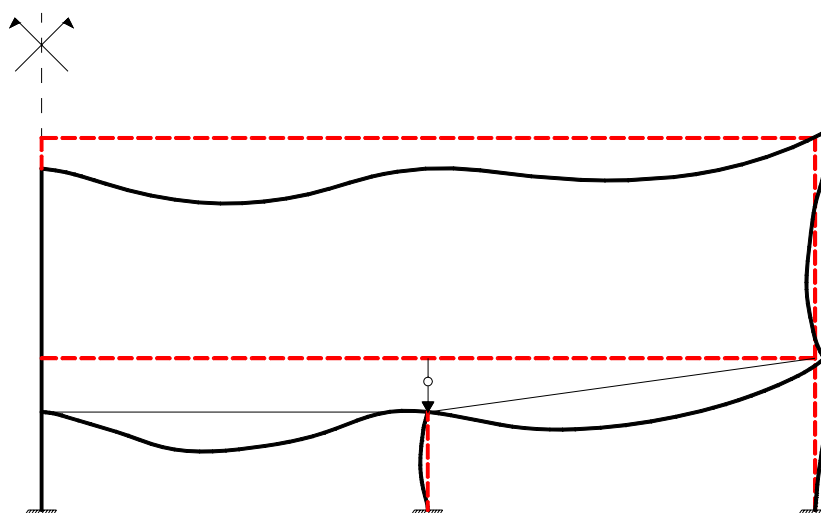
Funcionamento esquemático da viga-parede. a vermelho a configuração indeformada a negro a configuração deformada.
